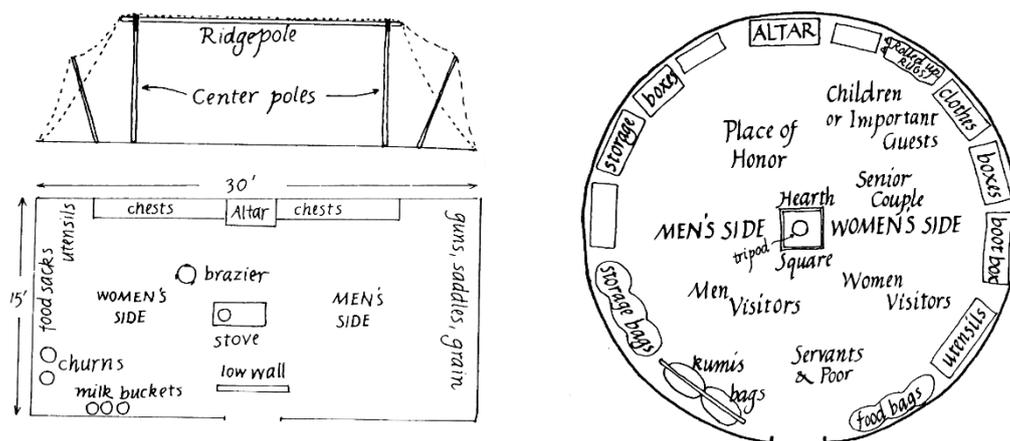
Izq. sección y planta de una tienda tibetana (a partir de Faegre 1979: 59). Der. planta de una yurta mongola (a partir de Faegre 1979: 91).
